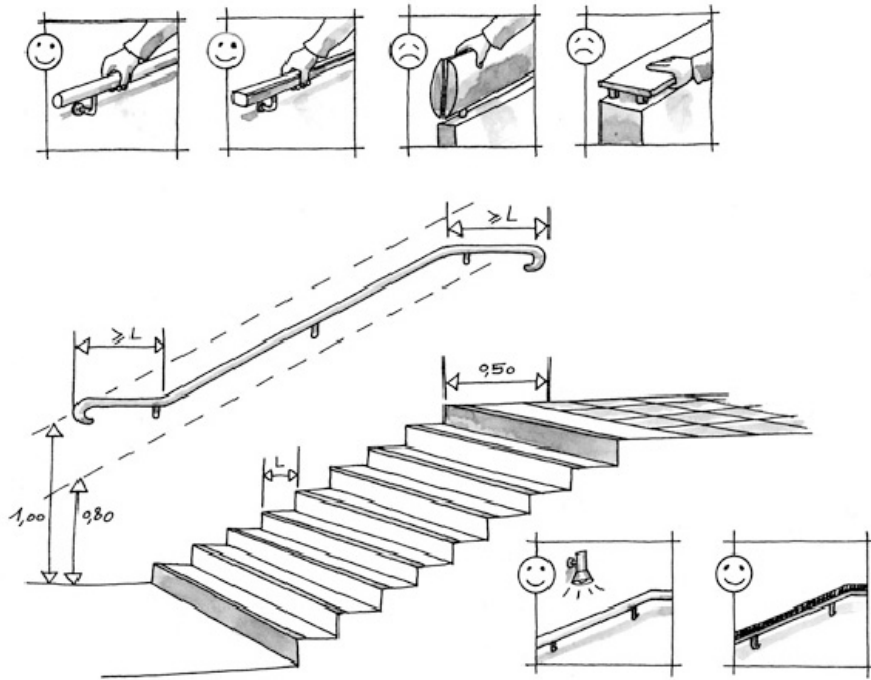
Exemples de mains courantes et d'escaliers accessibles
